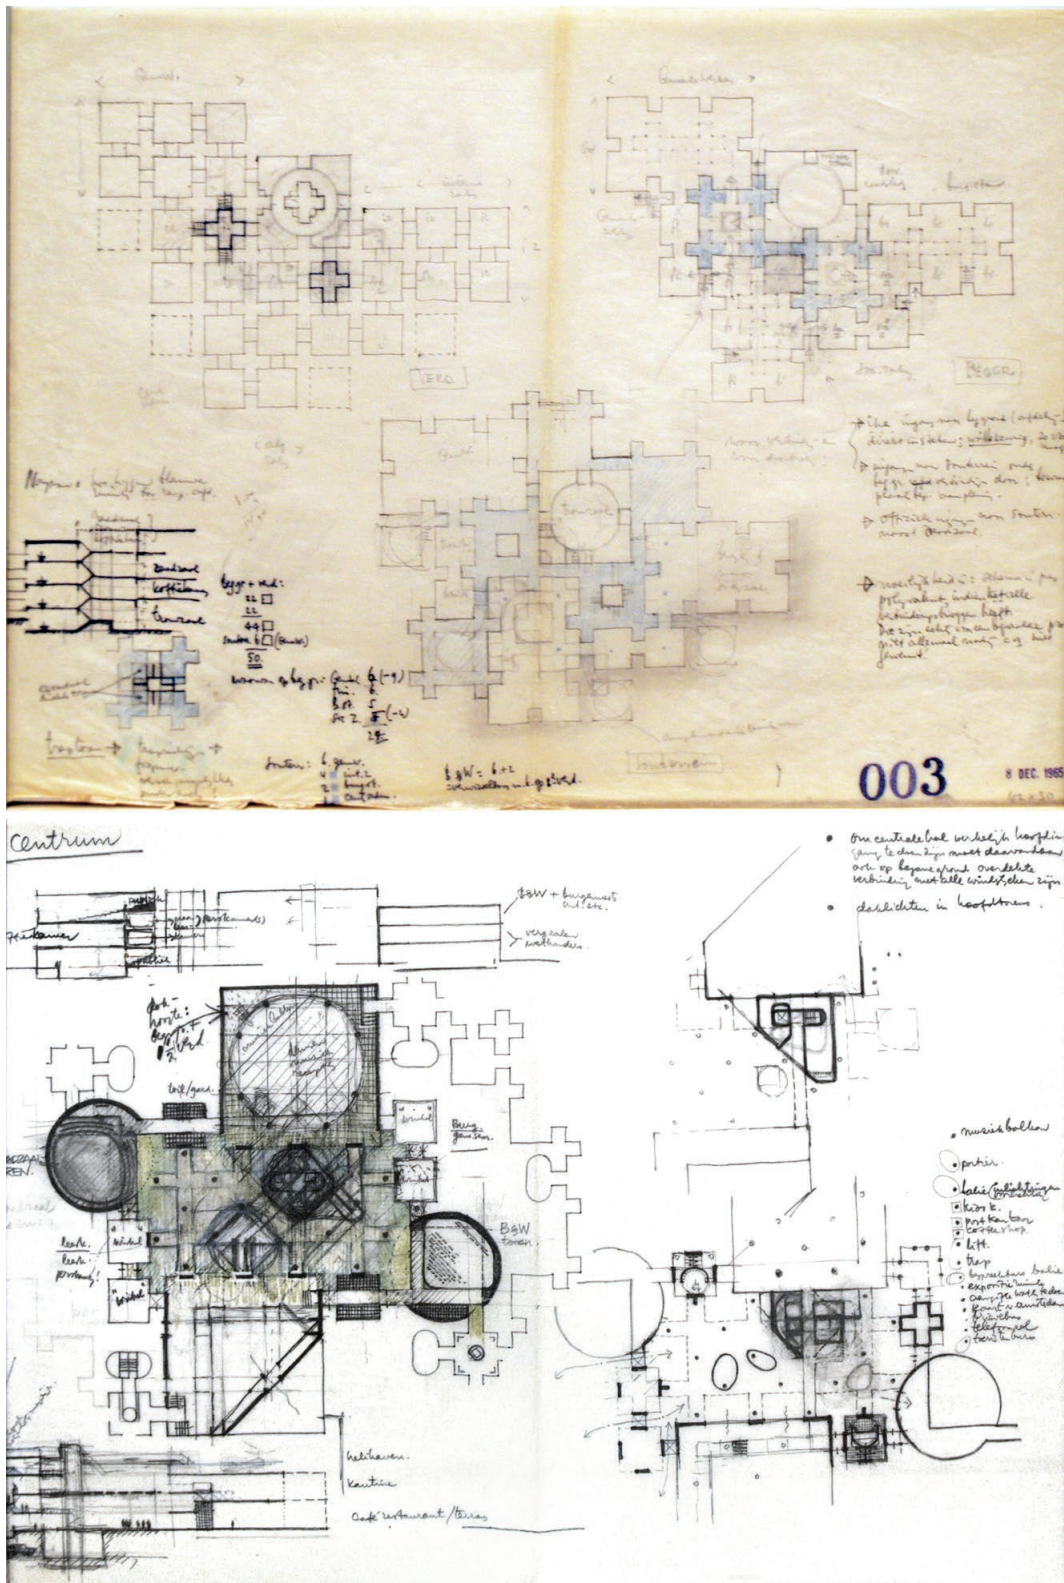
(a) Herman Hertzberger. Propuesta para el ayuntamiento de Valkenswaard. Croquis, diciembre de 1965. Análisis de configuraciones en planta baja, primera y sótano. (b) Herman Hertzberger. Propuesta para el ayuntamiento de Ámsterdam. Croquis, octubre de 1967. Análisis de distintas configuraciones en planta y sección.
